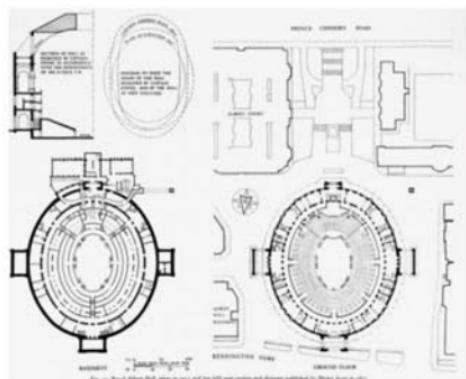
, 3. План и фасад здания театра Royal Albert Hall (Лондон)
